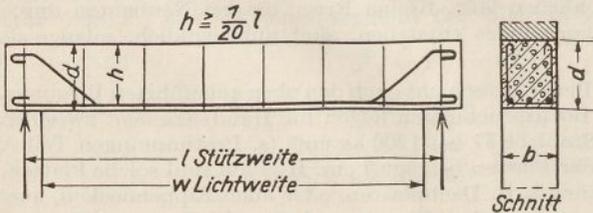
Eisenbetonbalken, freie Auflagerung.
